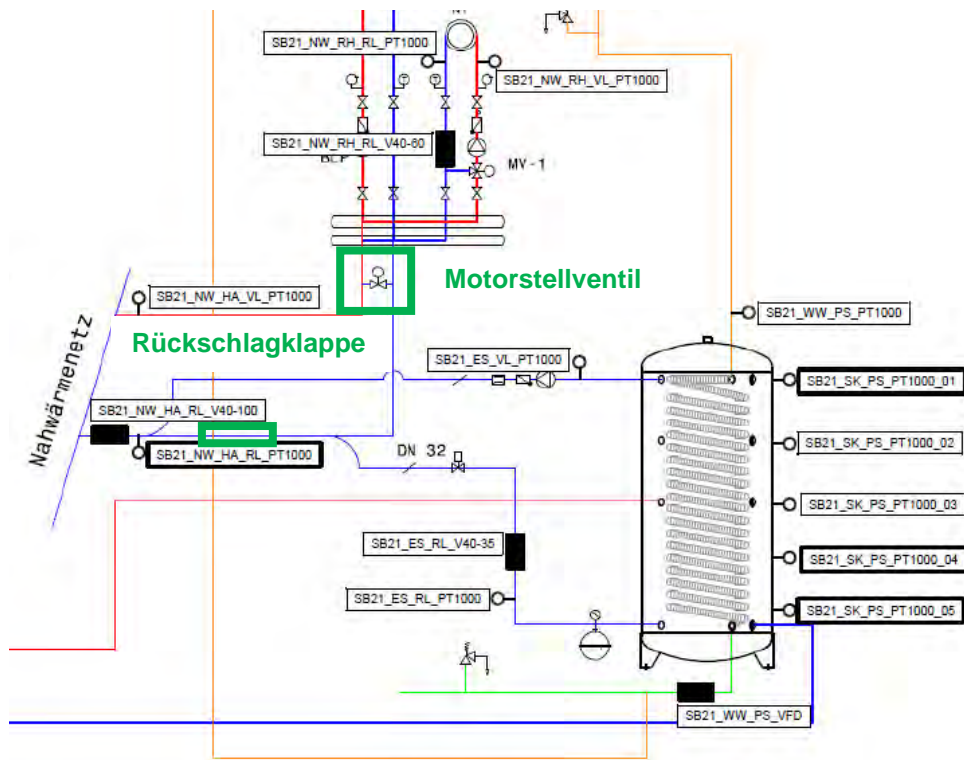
Ausschnitt Hydraulikschema Schubertstraße 21 mit Motorstellventil und Rückschlagklappe (grün markiert)
